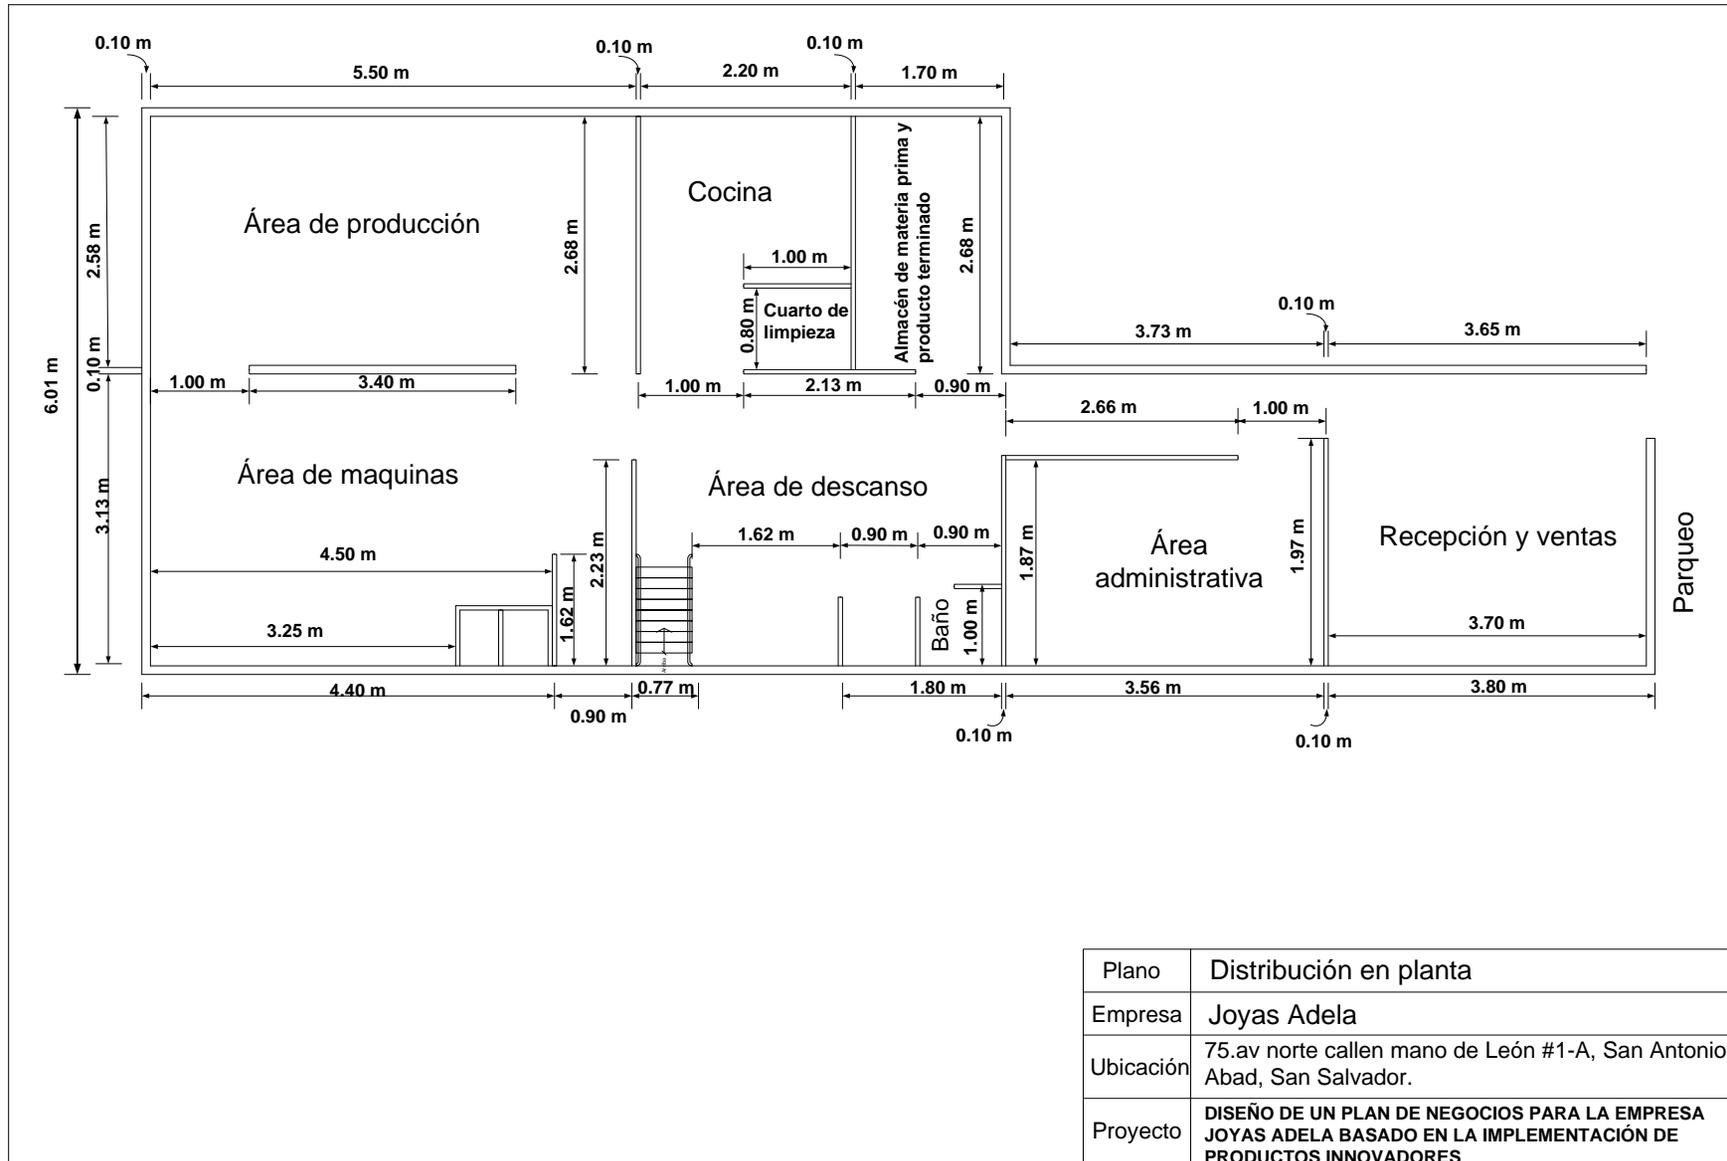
Plano distribución en planta. Fuente: elaboración propia
